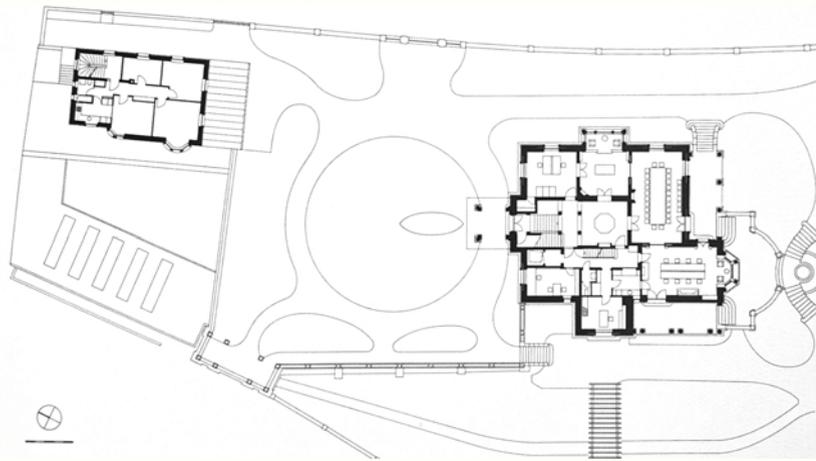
Grundrisse Villa Bleuler v.o.n.u.
